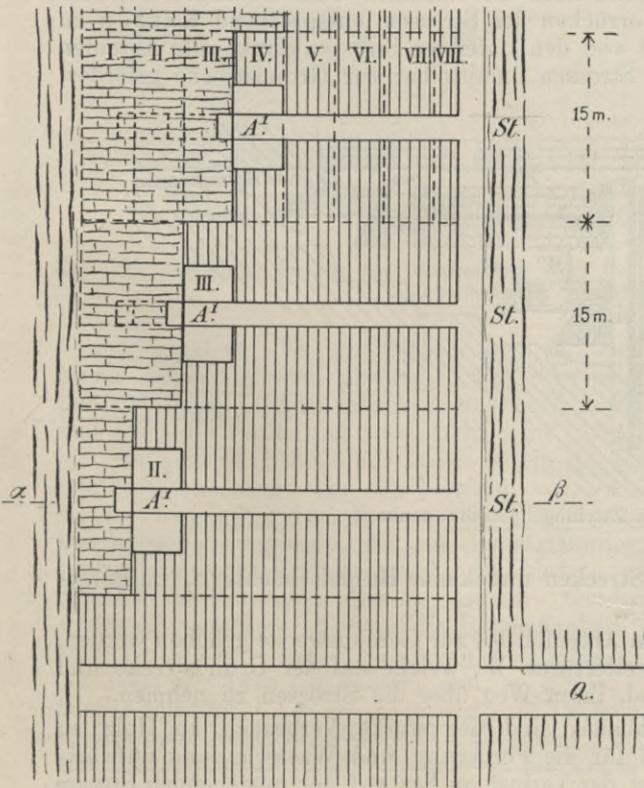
Grundriß; Schnitt durch die untere Hauptstrecke.
